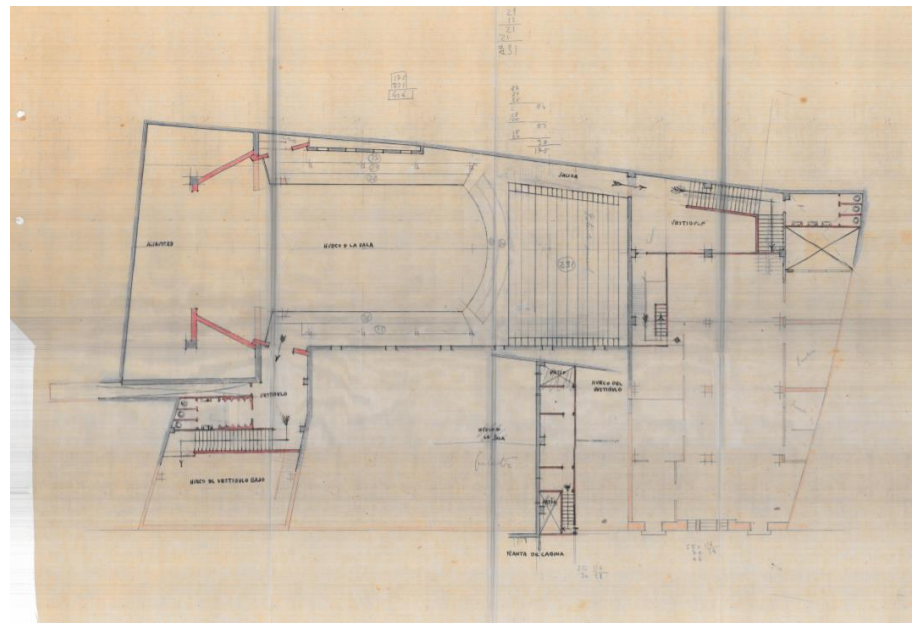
Plano planta 1 de la reconstrucción del teatro Musical
